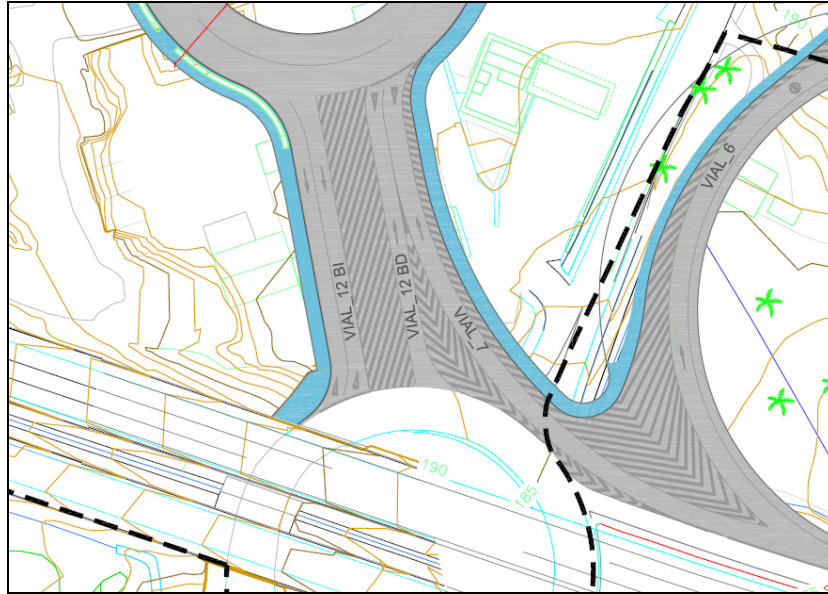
Acceso al barrio y a la vía perimetral por el enlace de la autovía
